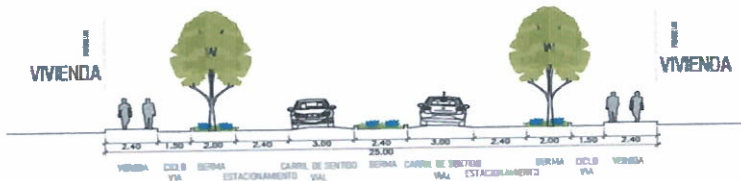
SECCIONES VIALES EQUIPO TECNICO
